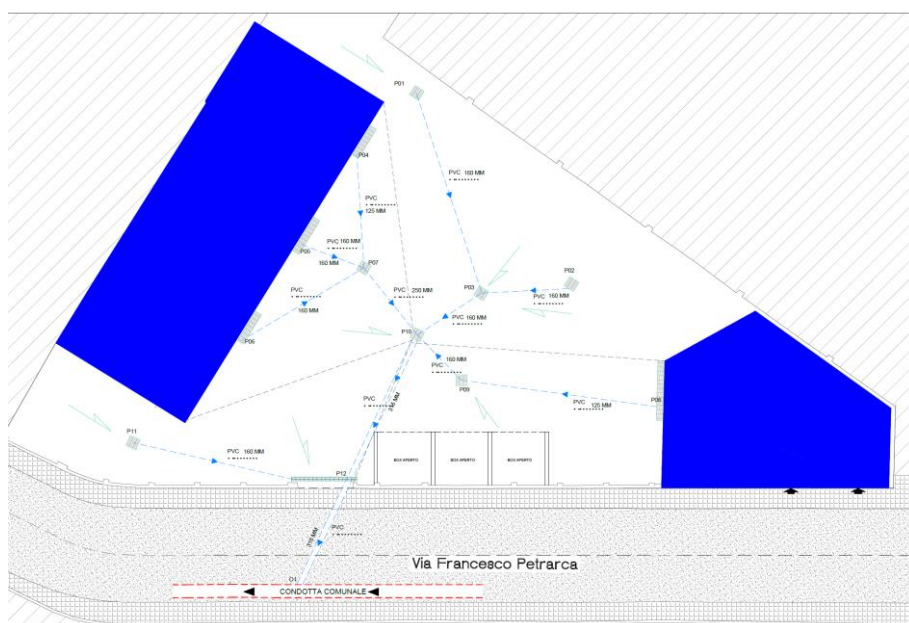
Planimetria Generale di Progetto: Rete di smaltimento delle acque meteoriche.
